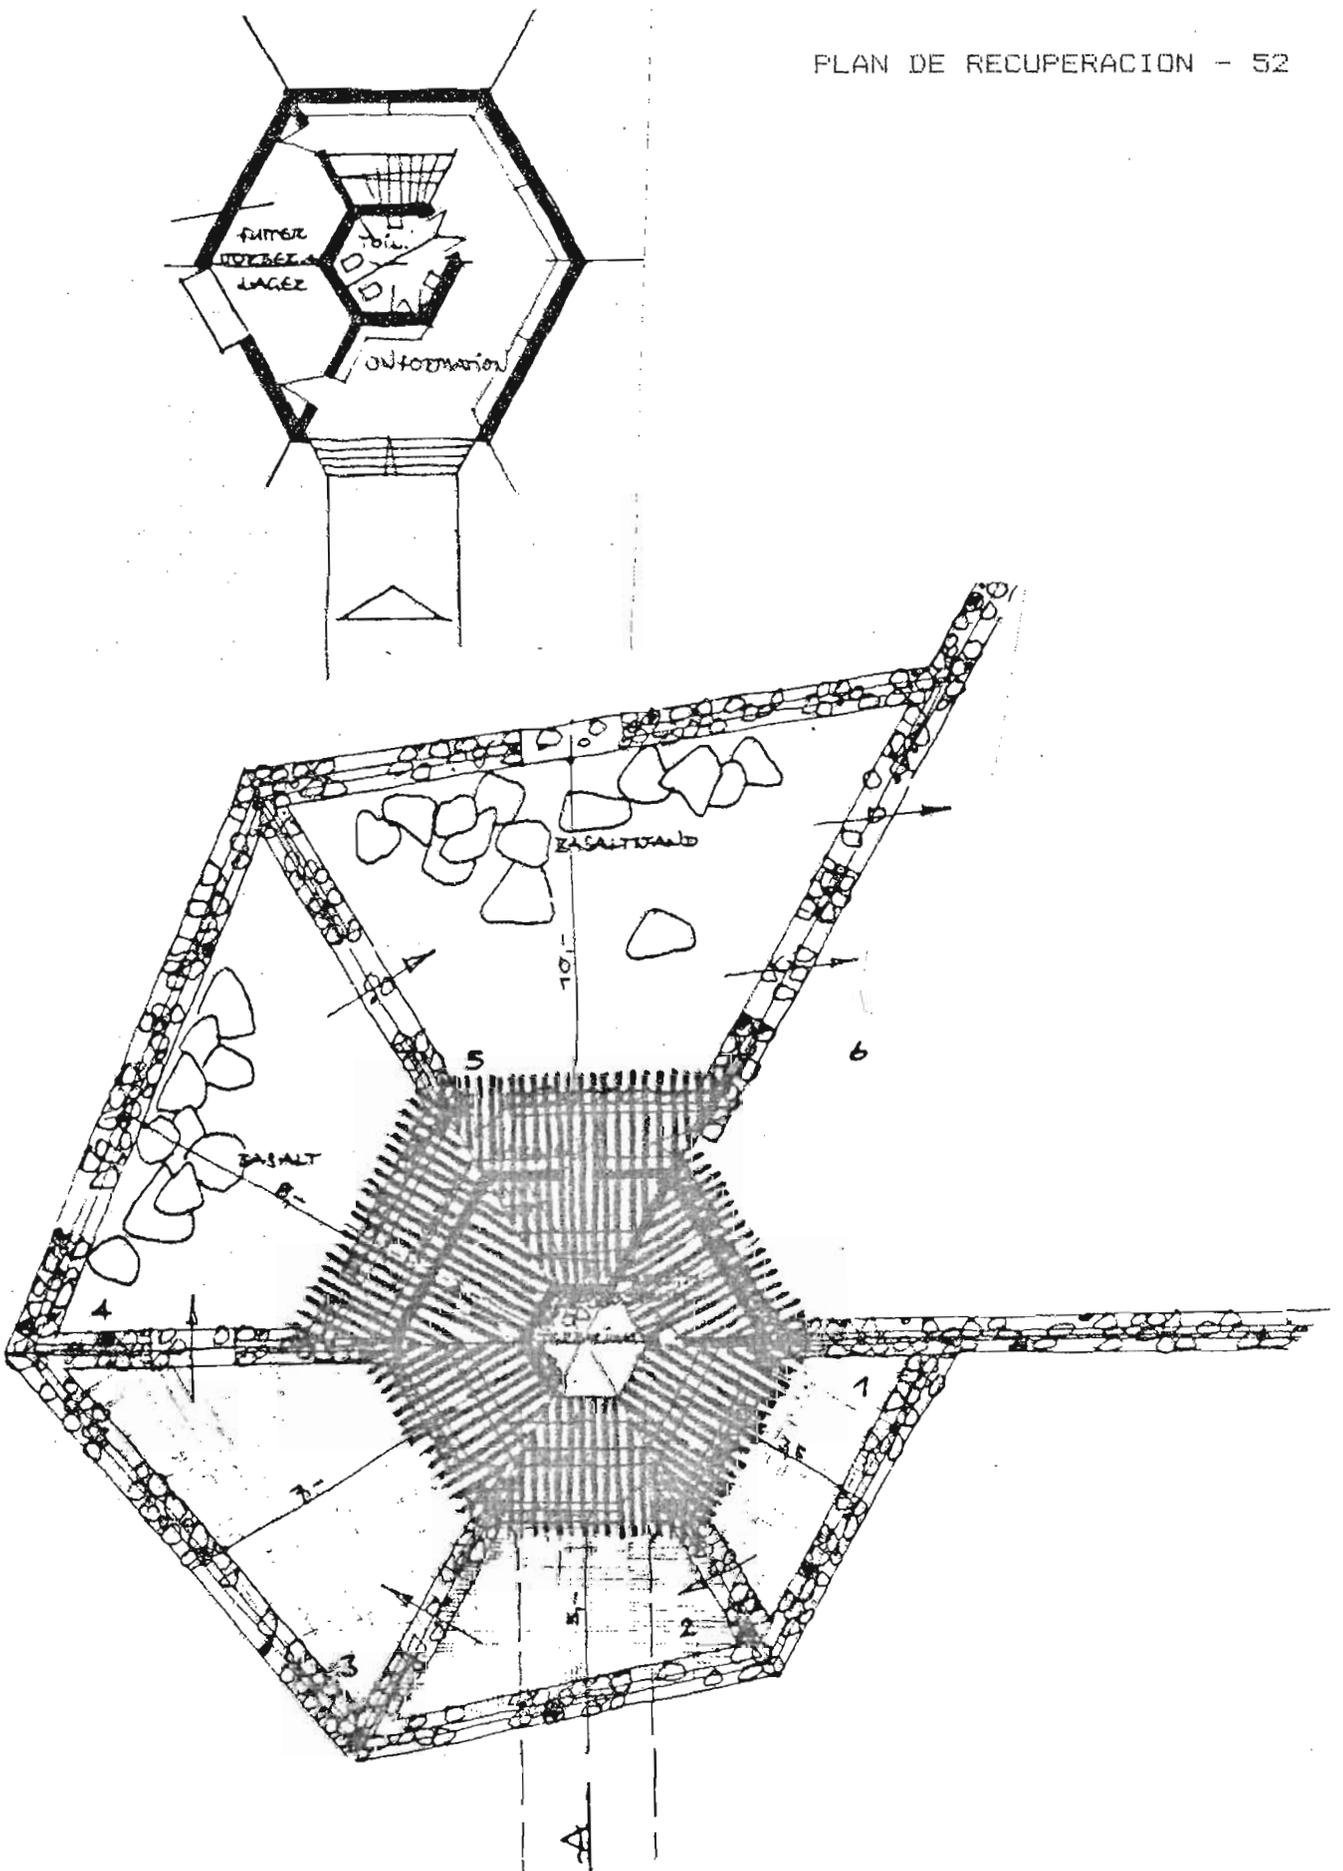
Planta alta y planta baja de la Unidad de Cría.
